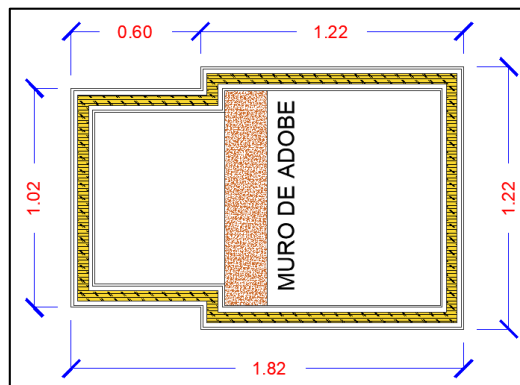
Disposición del muro de adobe, Fuente: Elaboración Propia
